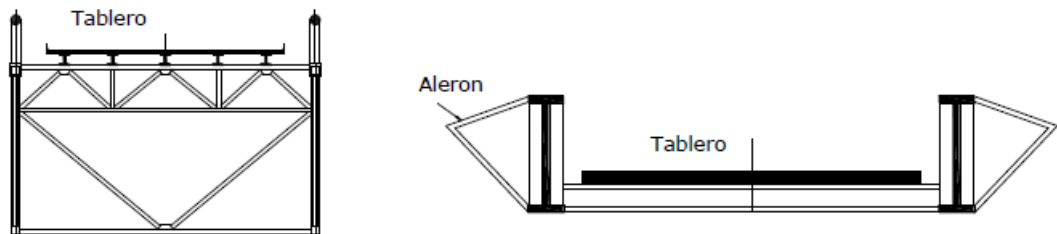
Tableros de puentes colgantes, a) Viga reticulada, b) Vigas I con estabilizadores aerodinámicos
